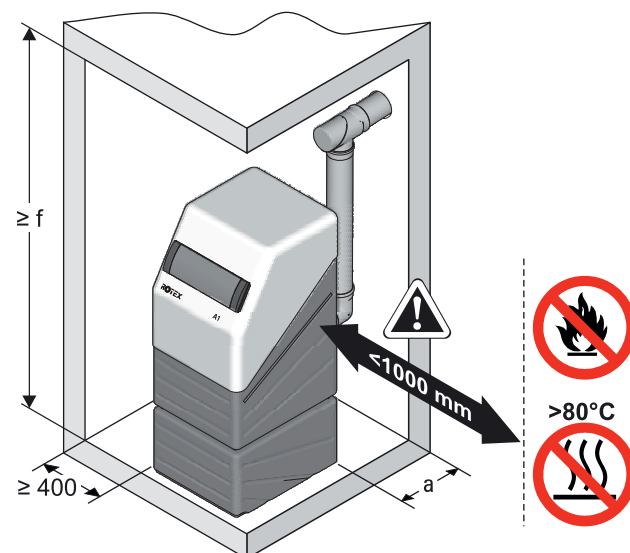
Distanze minime per l'installazione di A1 BG (legenda v. tab. 4-2)
